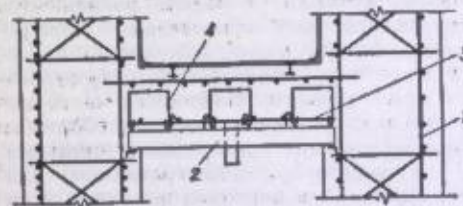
Сборно-монолитное перекрытие: 1 — фермопакеты стен; 2 — сборная железобетонная опалубочная плита; 3 — арматура под швами плит; 4 — каркасы для поддержки верхних стенок.
